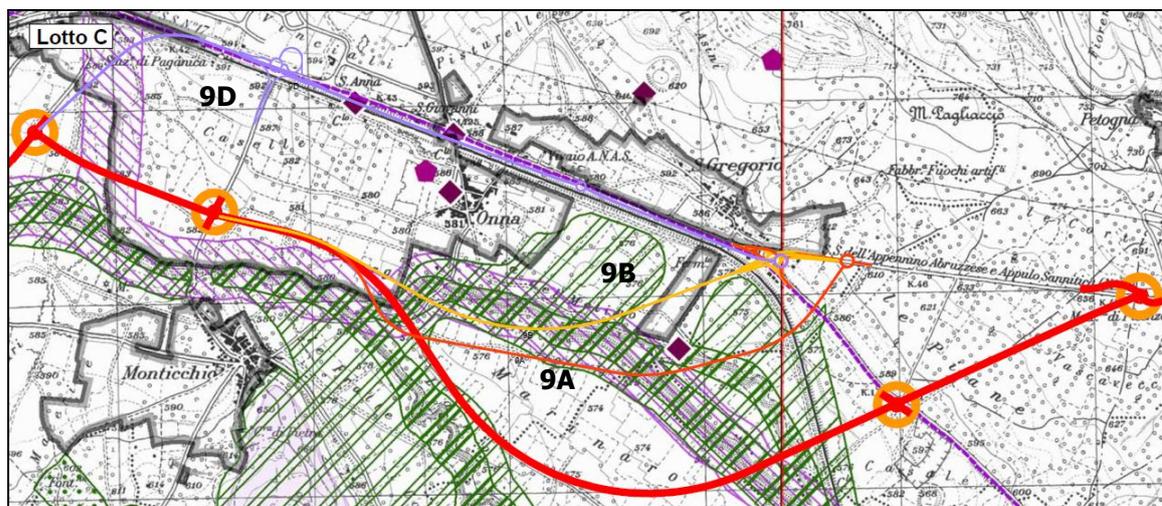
Stralcio planimetrico estratto dal P.R.P. in fase di approvazione con evidenza del tracciato di progetto (in rosso) e le alternative progettuali.
